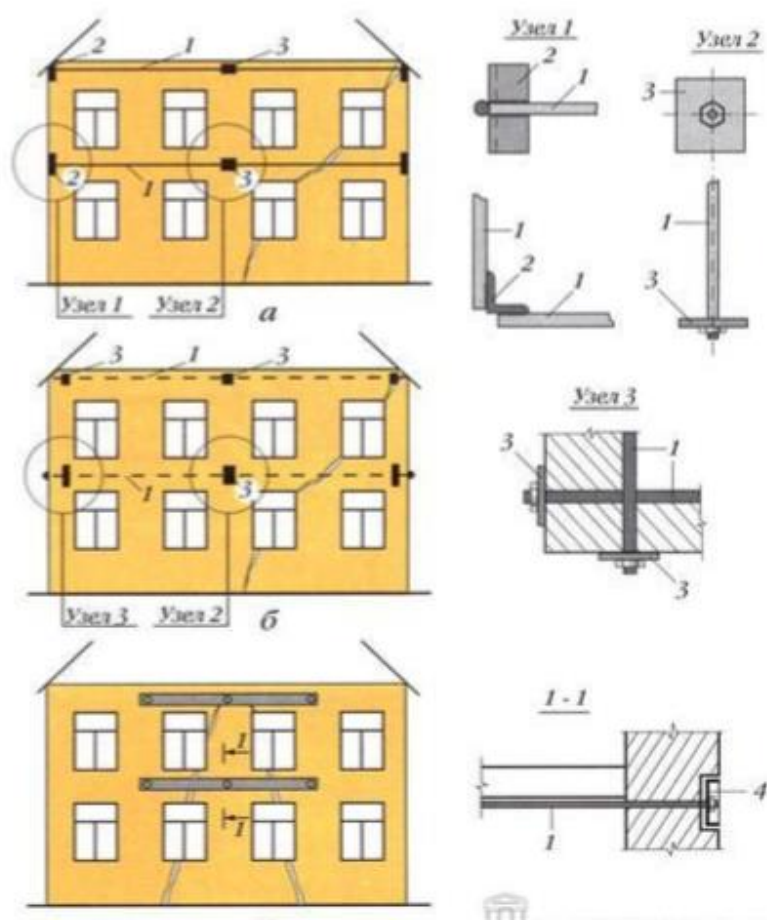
Усиление стен: а, б -стальными тяжами с наружной (а) и внутренней (б) сторон здания; в -установкой ненапрягаемых тяжей; 1 -тяж; 2 -уголок; 3 -опорная стальная пластинка; 4 -швеллер
